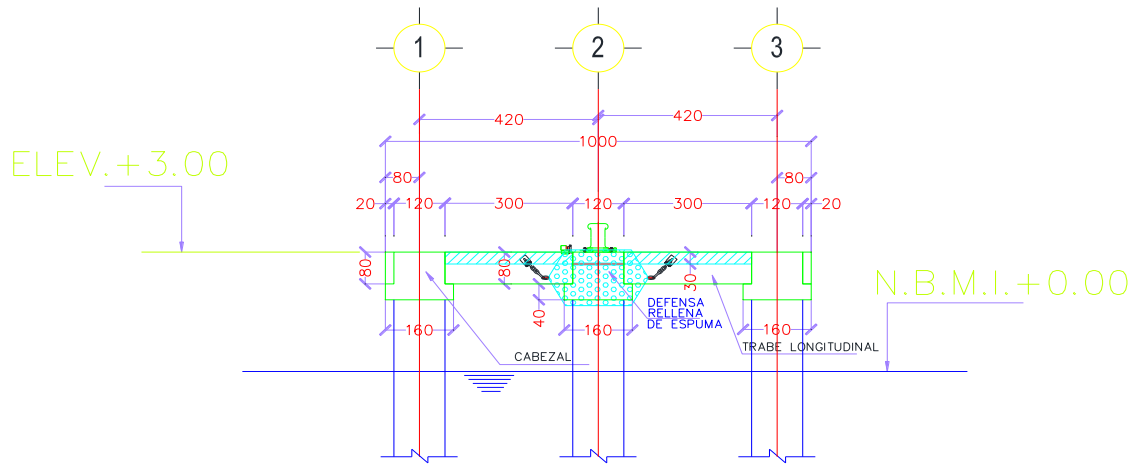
Detalle en planta para la construcción de duques de atraque y amarre.
